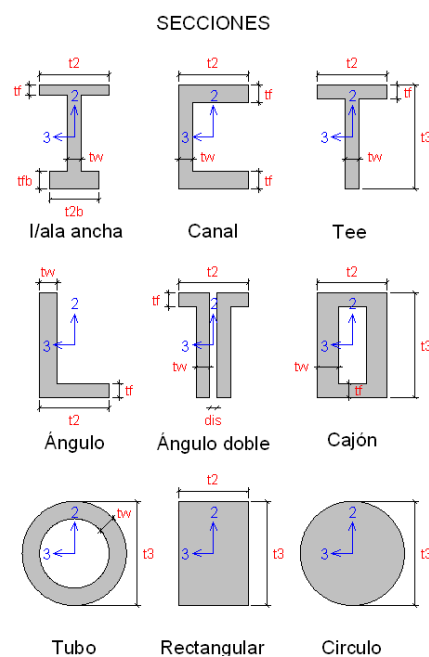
Plantillas de secciones para elementos tipo barra (Fuente: Taboada y De Izcue, 2009)
